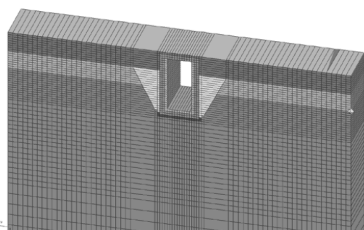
Расчетная схема поперечного профиля железобетонного лотка
